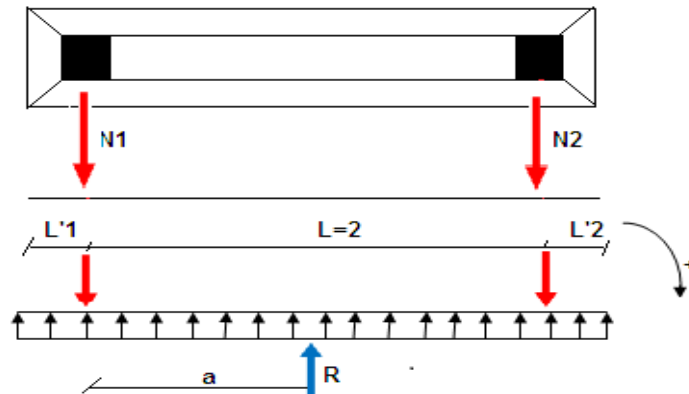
schéma statique de la semelle filante sous deux poteaux
